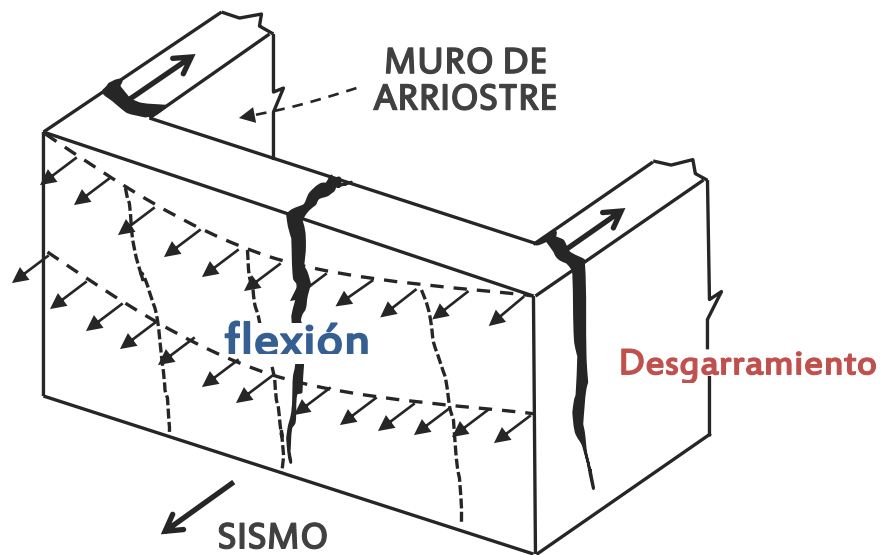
f.2-2) Esquematización de tipos de falla por flexión en mampostería, tanto en dirección paralela, como perpendicular (horizontal) al plano del muro
